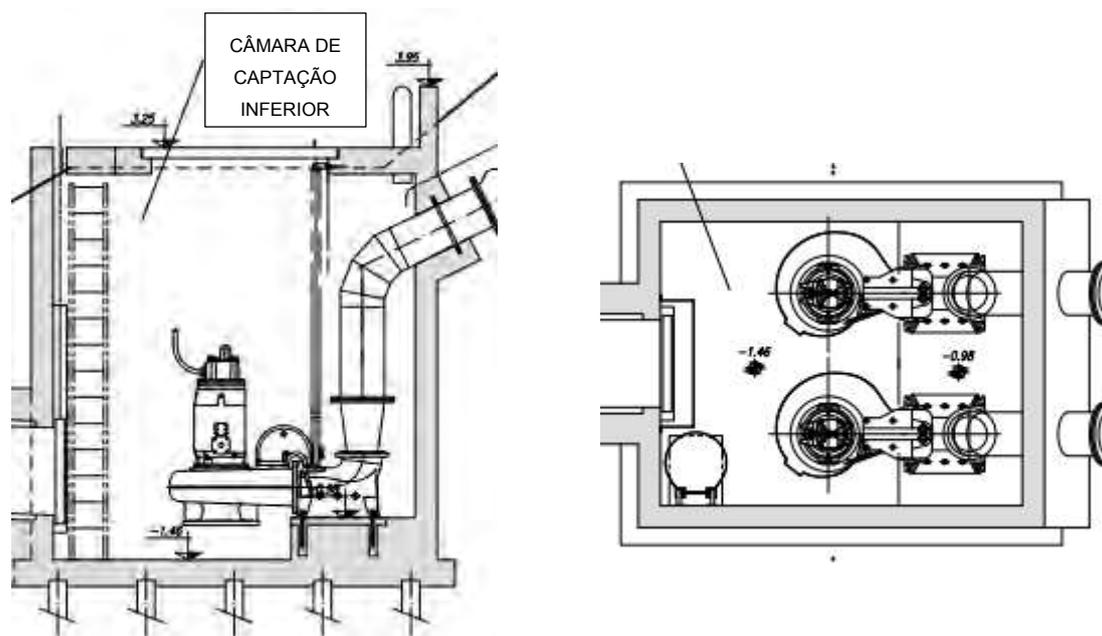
Solução tipo para a estação elevatória (corte à esquerda e planta à direita)
